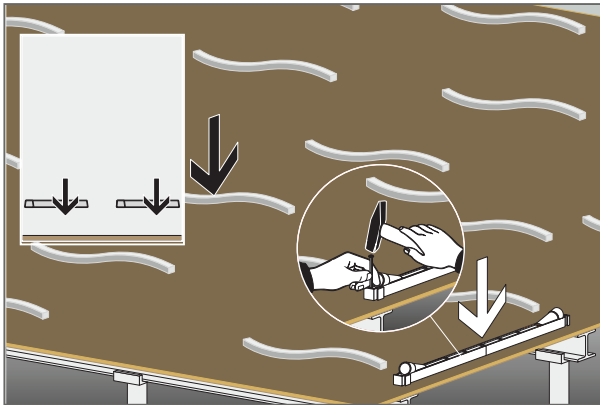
Montage der Deckendurchführung gemäß Projektplanung und Auslegen der bauseitigen Abstandhalter für die untere Bewehrung.
